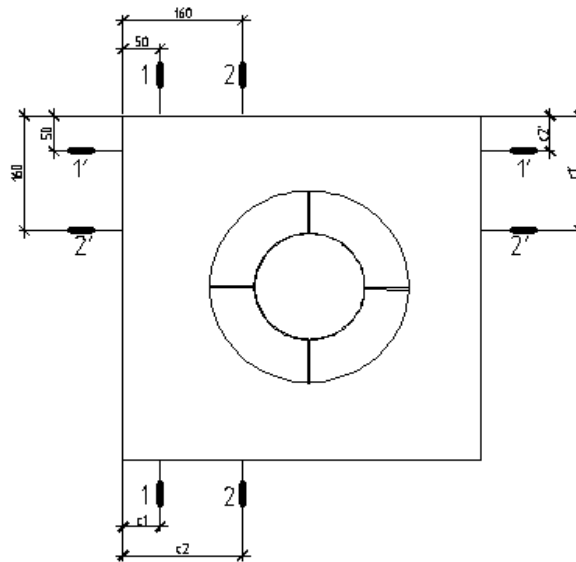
Схема до розрахунку армування плитної частини фундаменту
